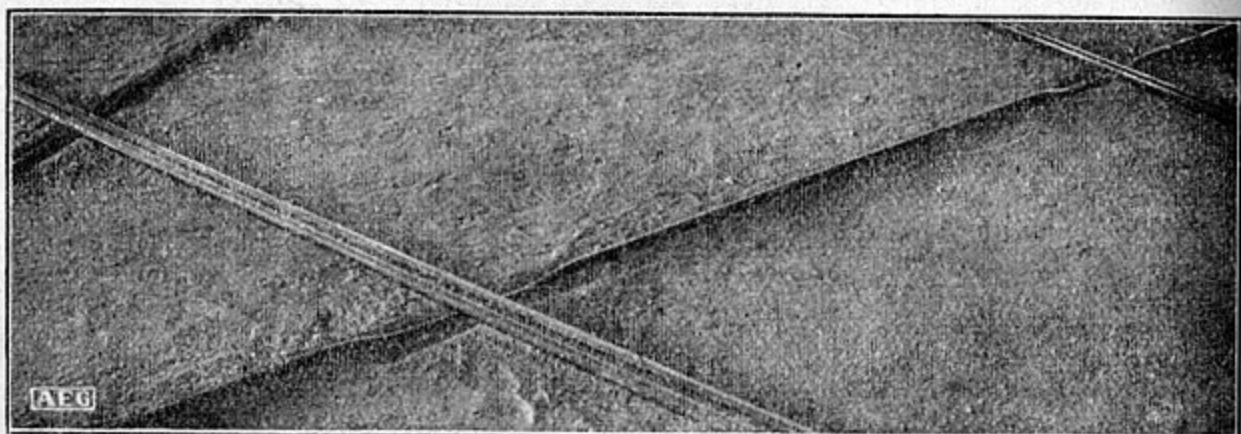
Kreuzung von Stahlpanzerrohren auf der Betondecke.
